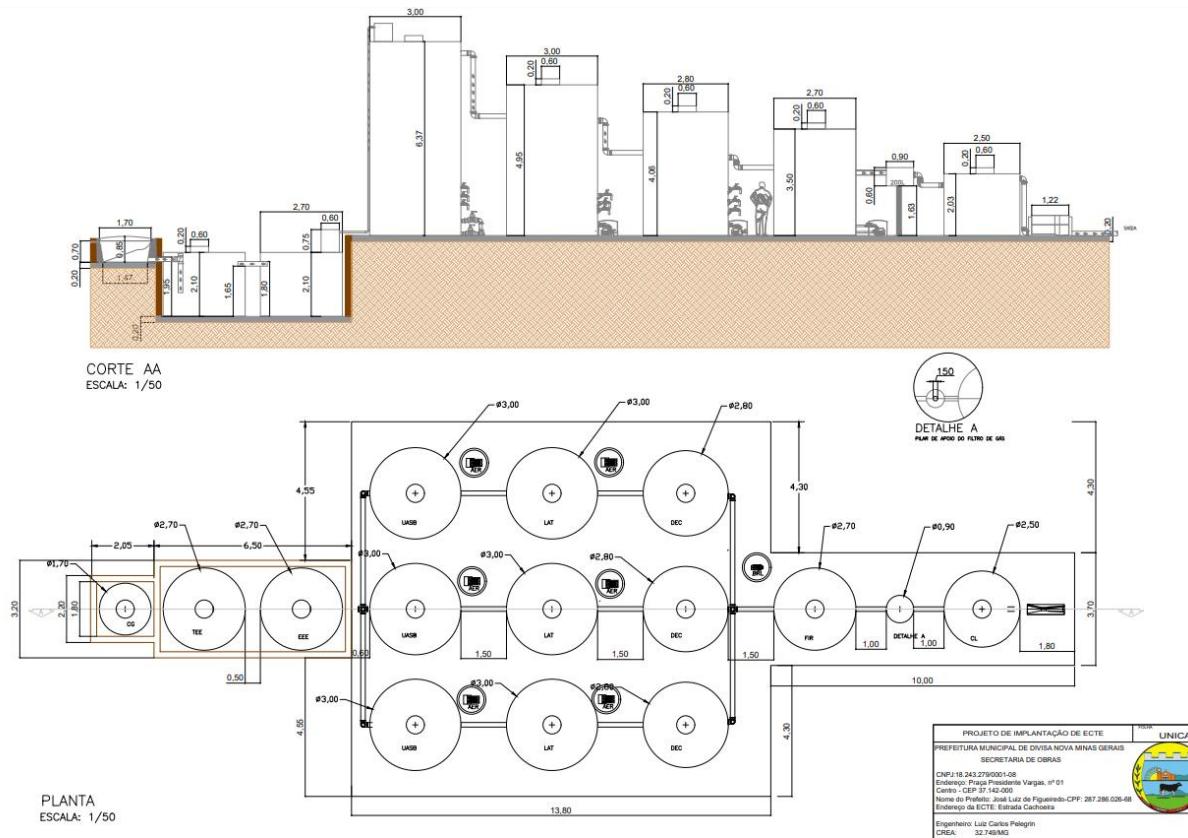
Planta e corte ETE Divisa Nova. Fonte: RAS
